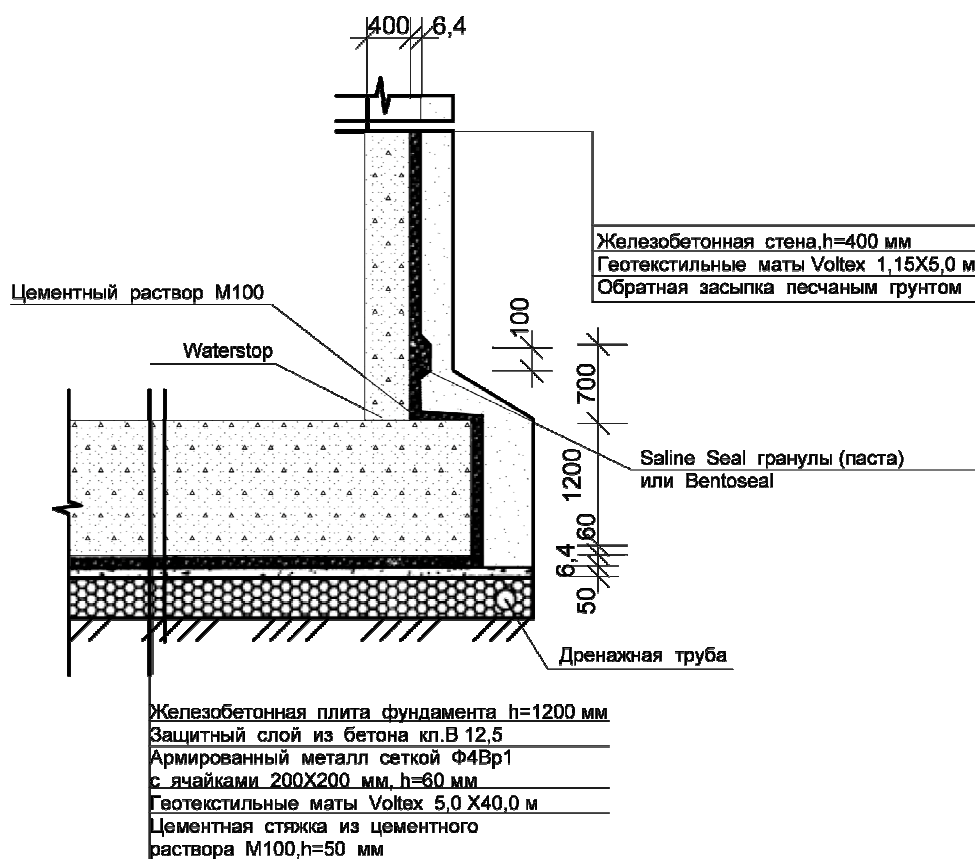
Наружная минеральная гидроизоляция бетонных плит оснований и стен подземных сооружений в условиях воздействия нескпливающейся фильтрационной воды
